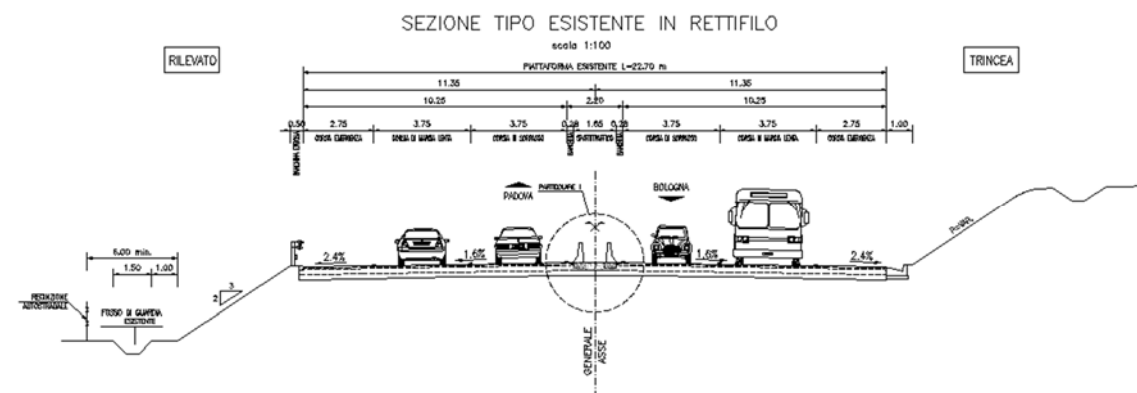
1 – Sezione tipo esistente in rilevato/trincea
